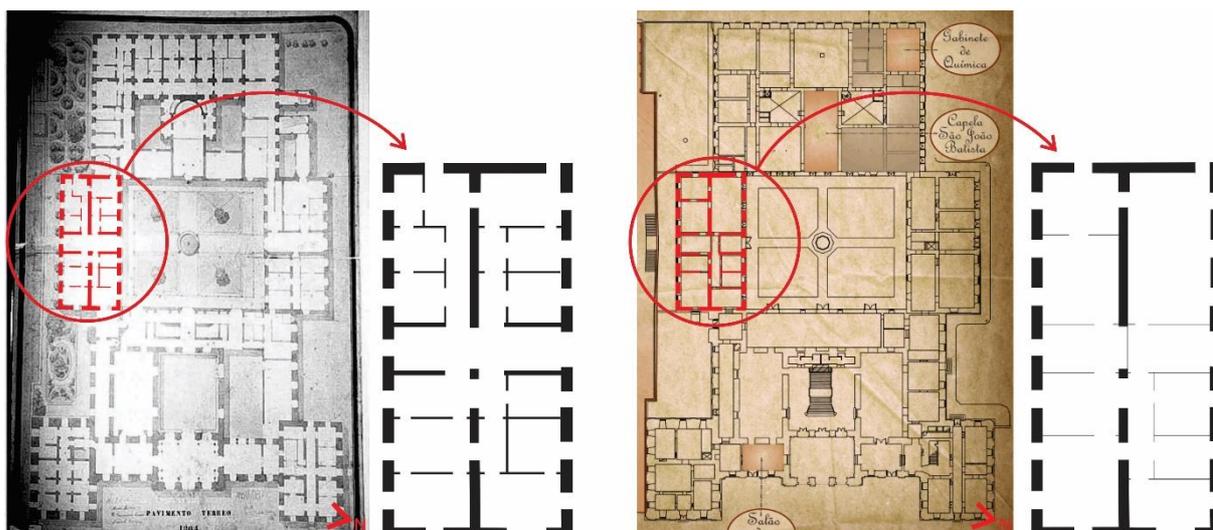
Planta baixa do 1º pavimento do PSC; à esquerda 1864 e à direita a planta baixa atual. Podemos também ver o Norte marcado nas plantas, no canto direito inferior.
